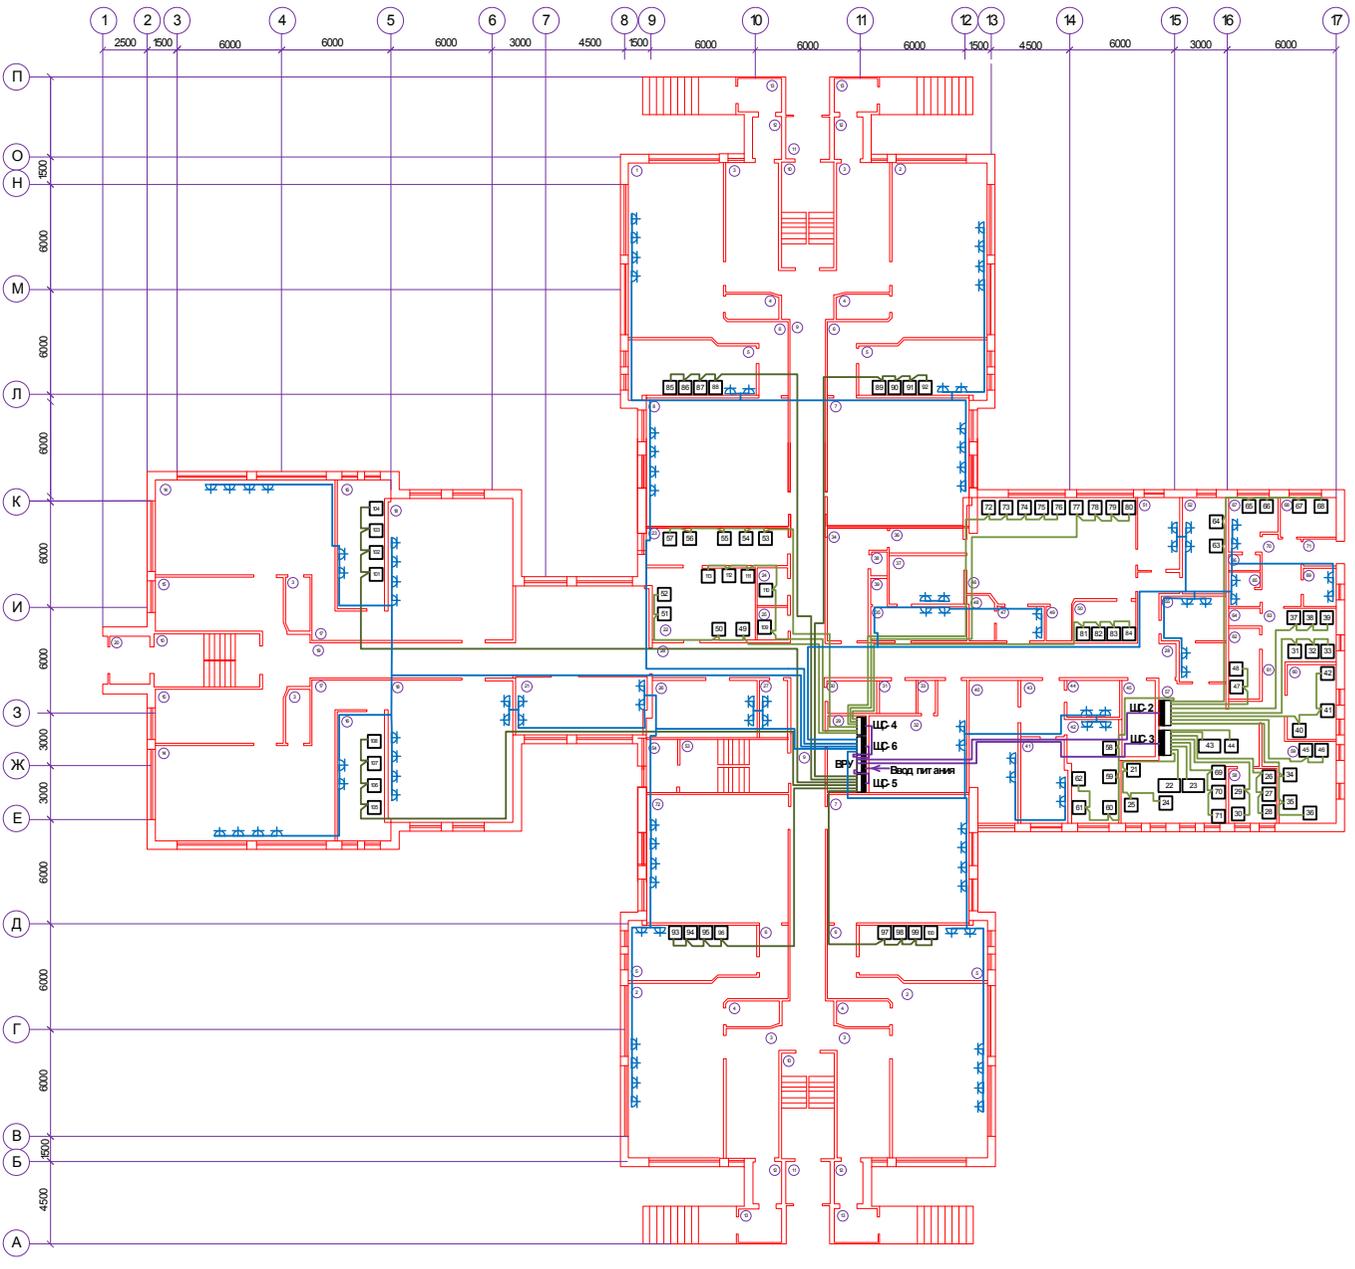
План силовых сетей 1-го этажа детского сада
